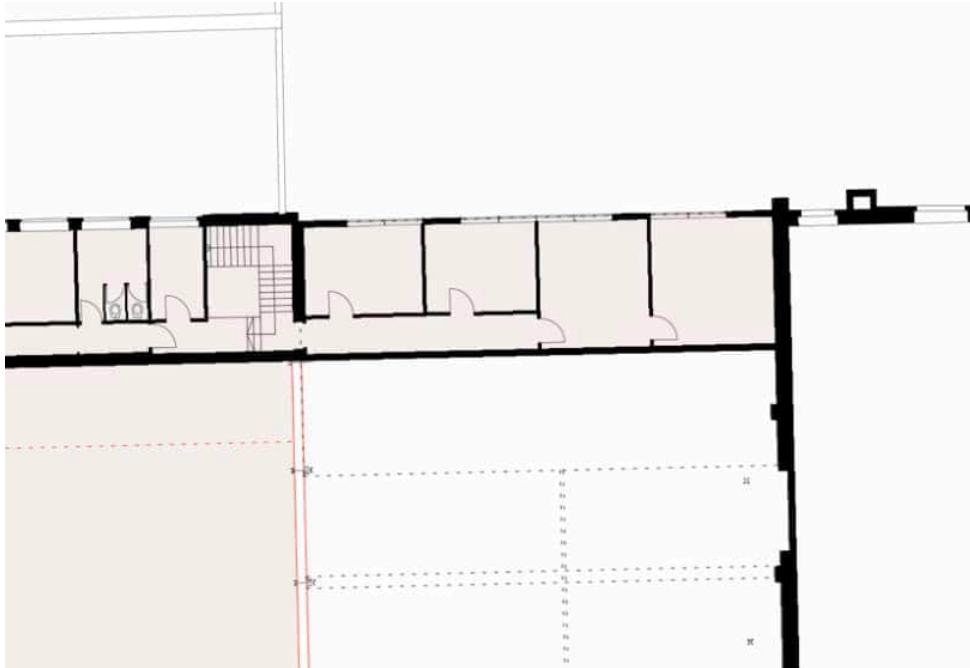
Grundriss 2. Obergeschoss R1 Schiff 1, coido architects
